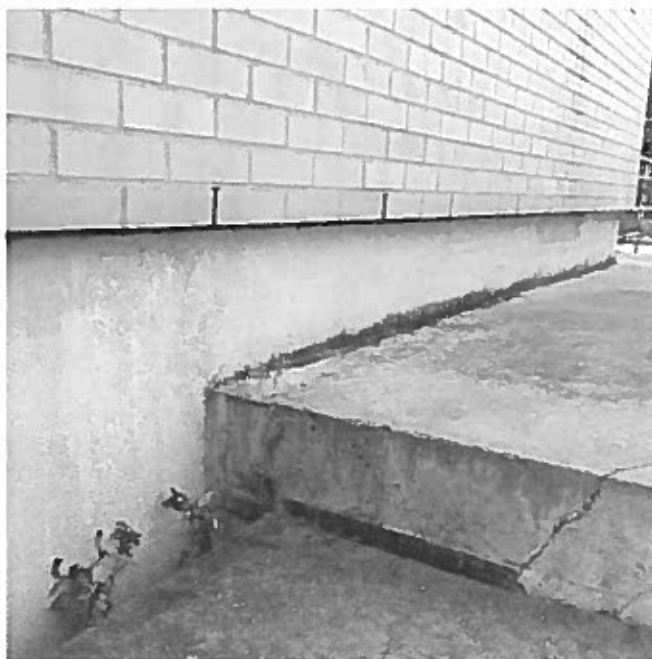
Extérieur – Fondation de béton recouvert de crêpi
